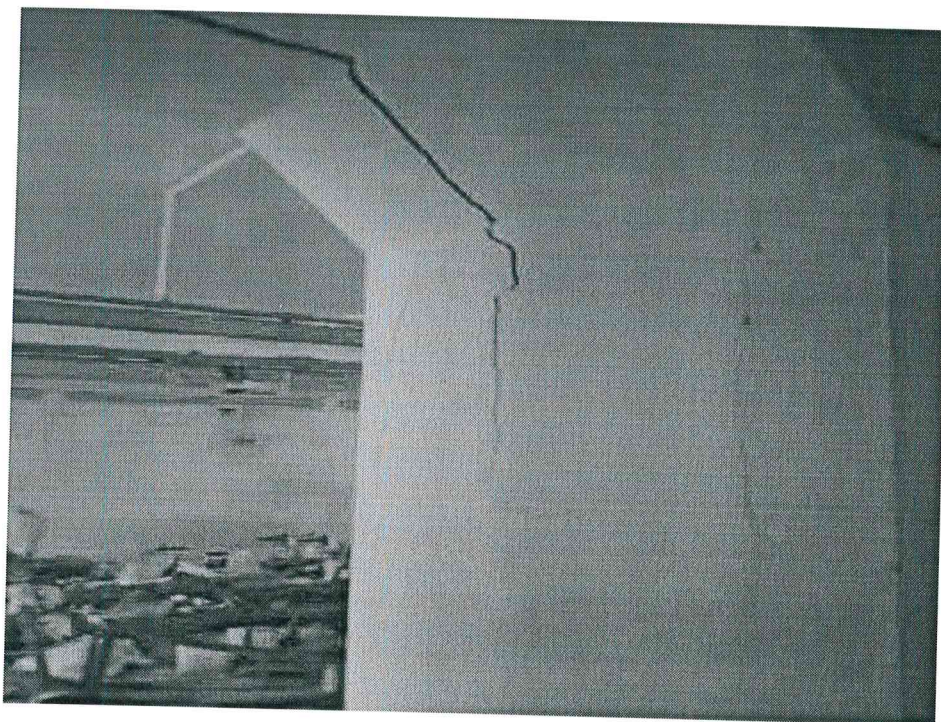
LOTTO 1: INTERNO DEL LABORATORIO
